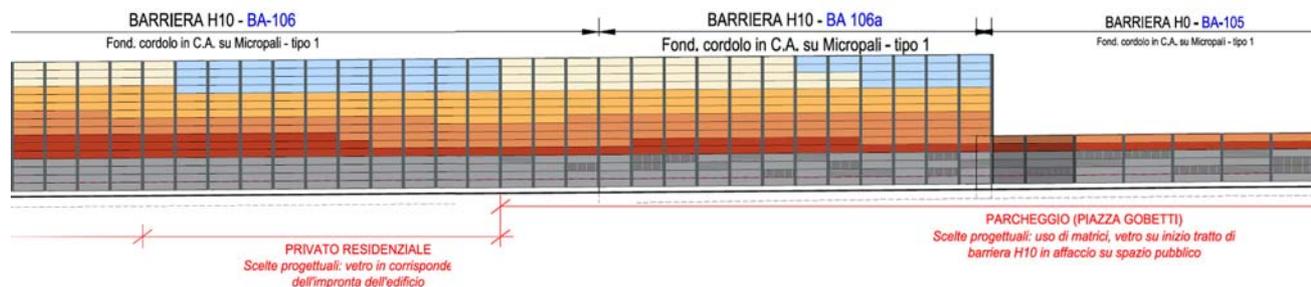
Sviluppo del prospetto delle barriere BA-106, BA-106a e BA-107 su BP
